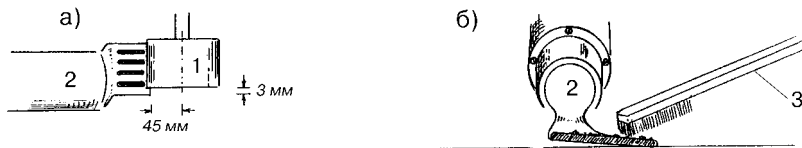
а) Расположение прикаточного ролика (1) и сопла (2);
